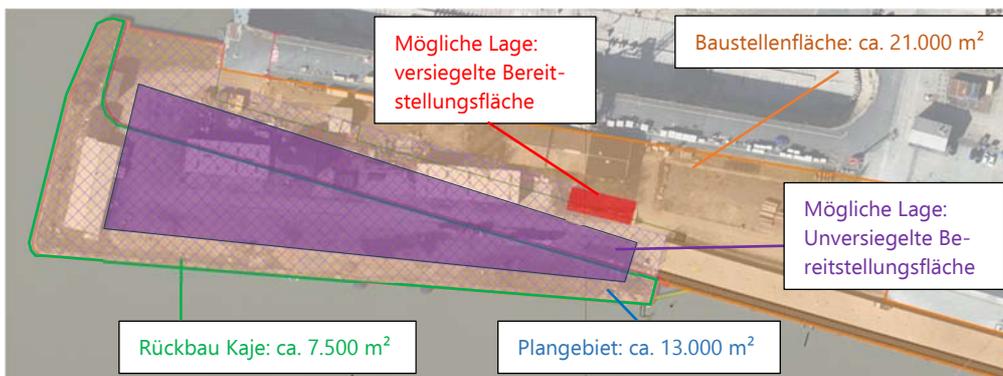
Darstellung der Teilflächen „Plangebiet, Baustellenfläche, Rückbau Kaje“; Ausschnitt aus der Planunterlage „Lageplan Baustellenfläche 2.9“ durch bremenports zur Verfügung gestellt.
